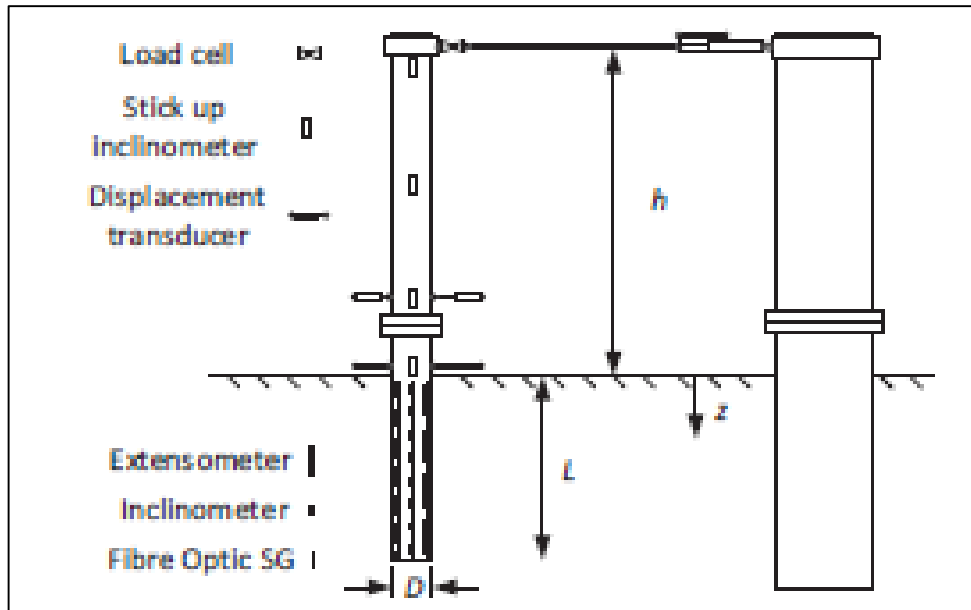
Parámetros de los ensayos del proyecto PISA. Fuente: Proyecto Pisa.
